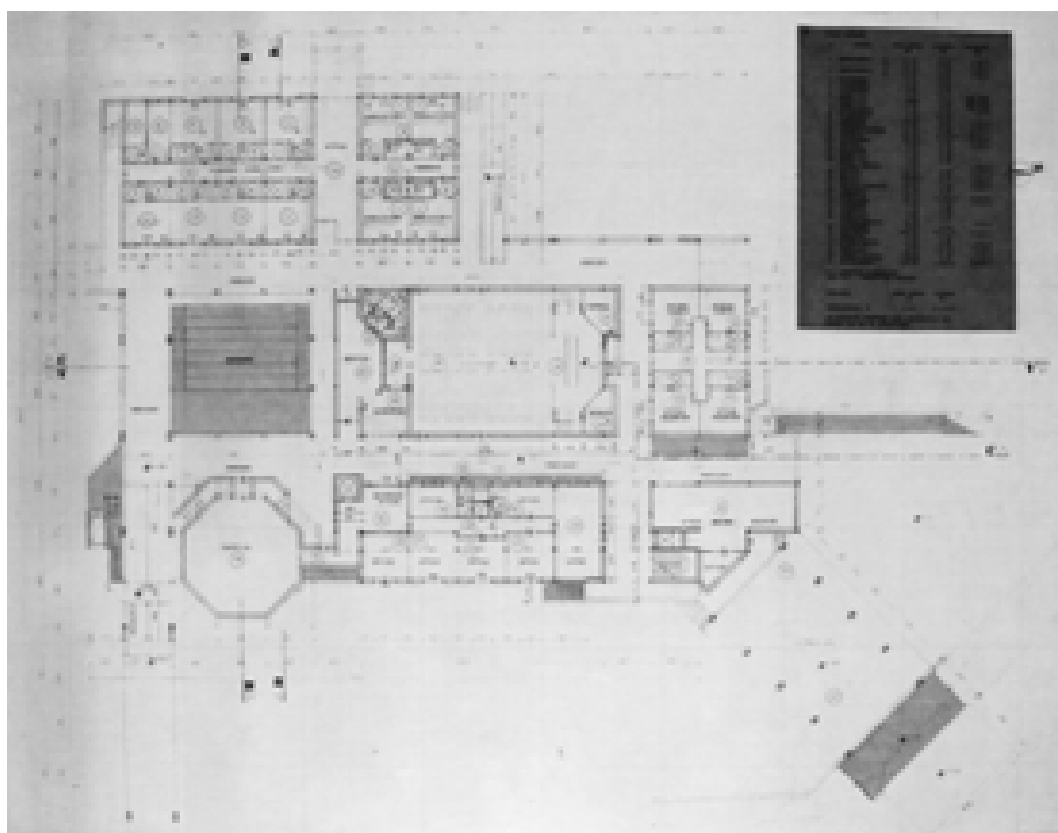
Pianta +1,00, stato futuro – 12/09/1991 (AABS-64_546)
